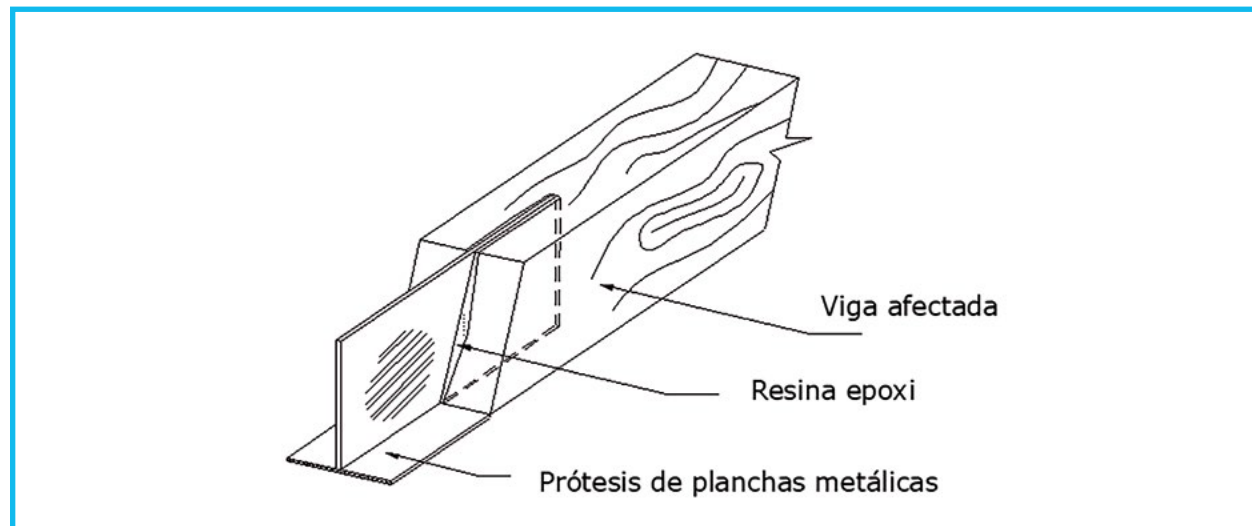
Refuerzo del cabezal con prótesis de planchas metálicas
